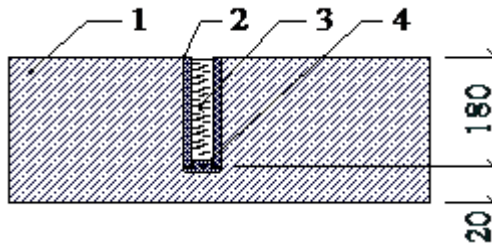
Устройство температурной скважины: 1 – бетон плиты перекрытия; 2 трубка ПВХ 25; теплопроводная жидкость – масло; 4 – заглушка
